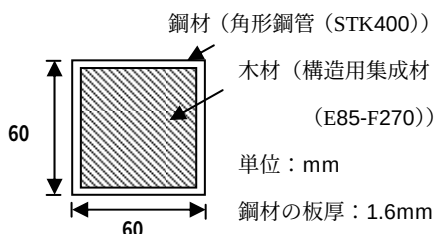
鋼材と木材からなるハイブリッド断面部材の断面図
